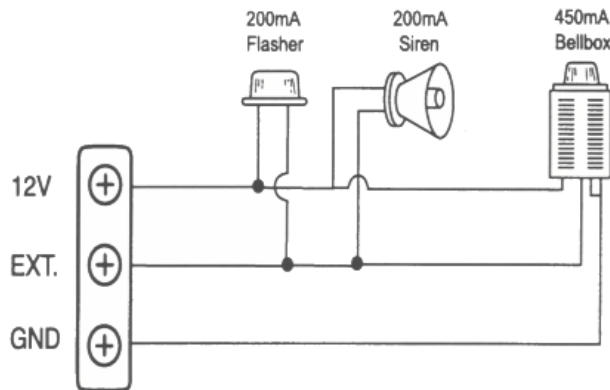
installation d'accessoires supplémentaires sur la tablette à bornes
